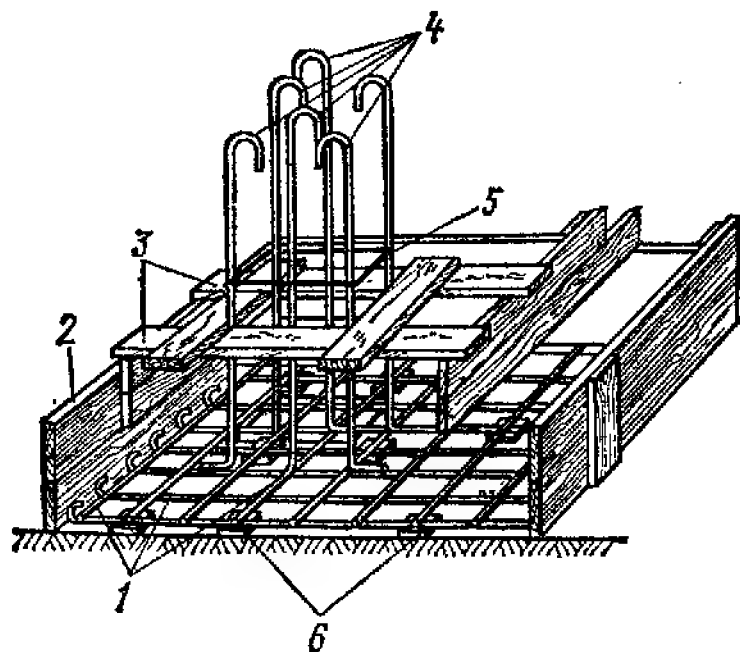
Схема установки арматуры в фундаментах и выпусков для колонн:
